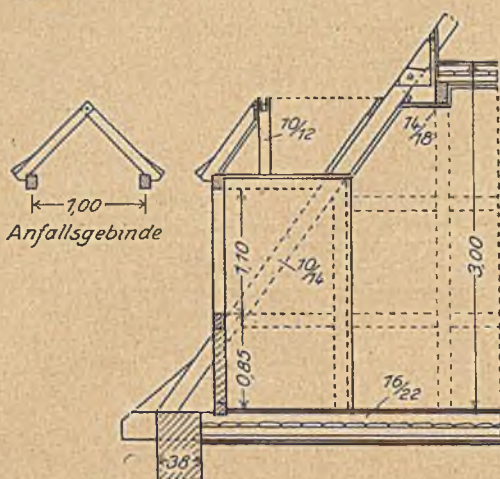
Dachfenster mit abgewalmtem Satteldach.
